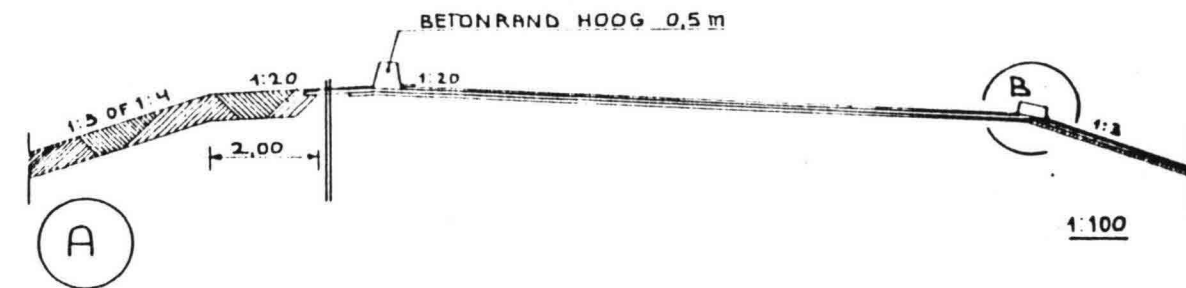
(VOOR BEKKENTYPE 18/12 m)
